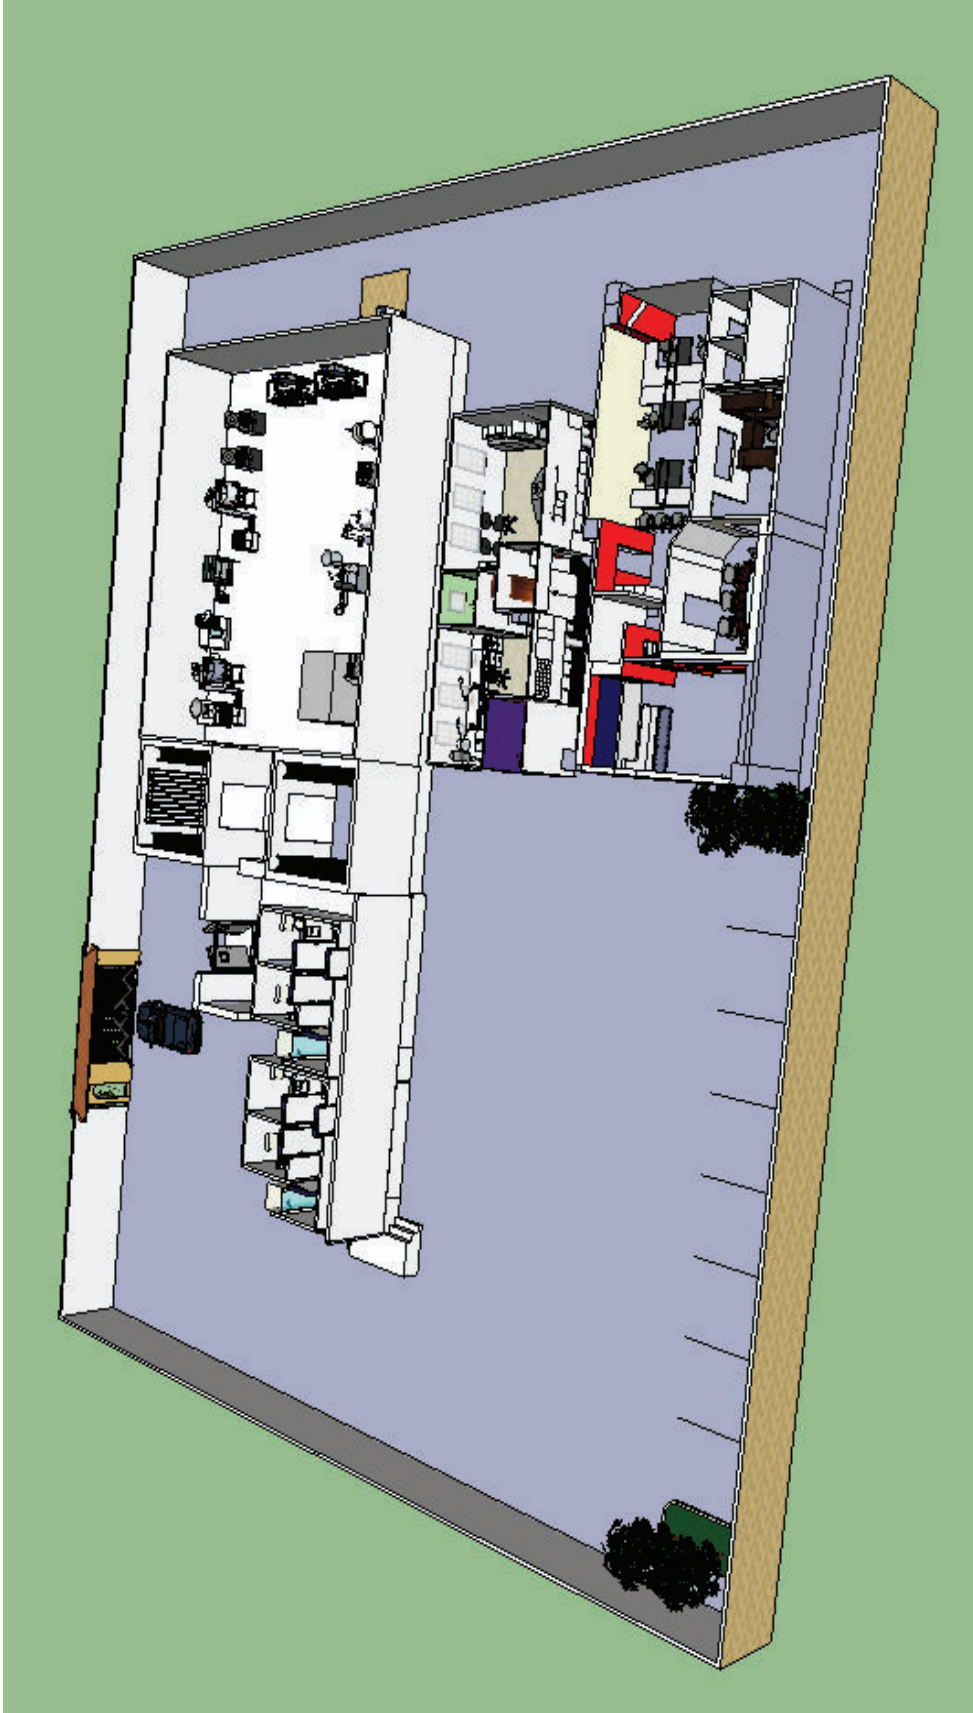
Perspectiva 3D de la planta piloto
